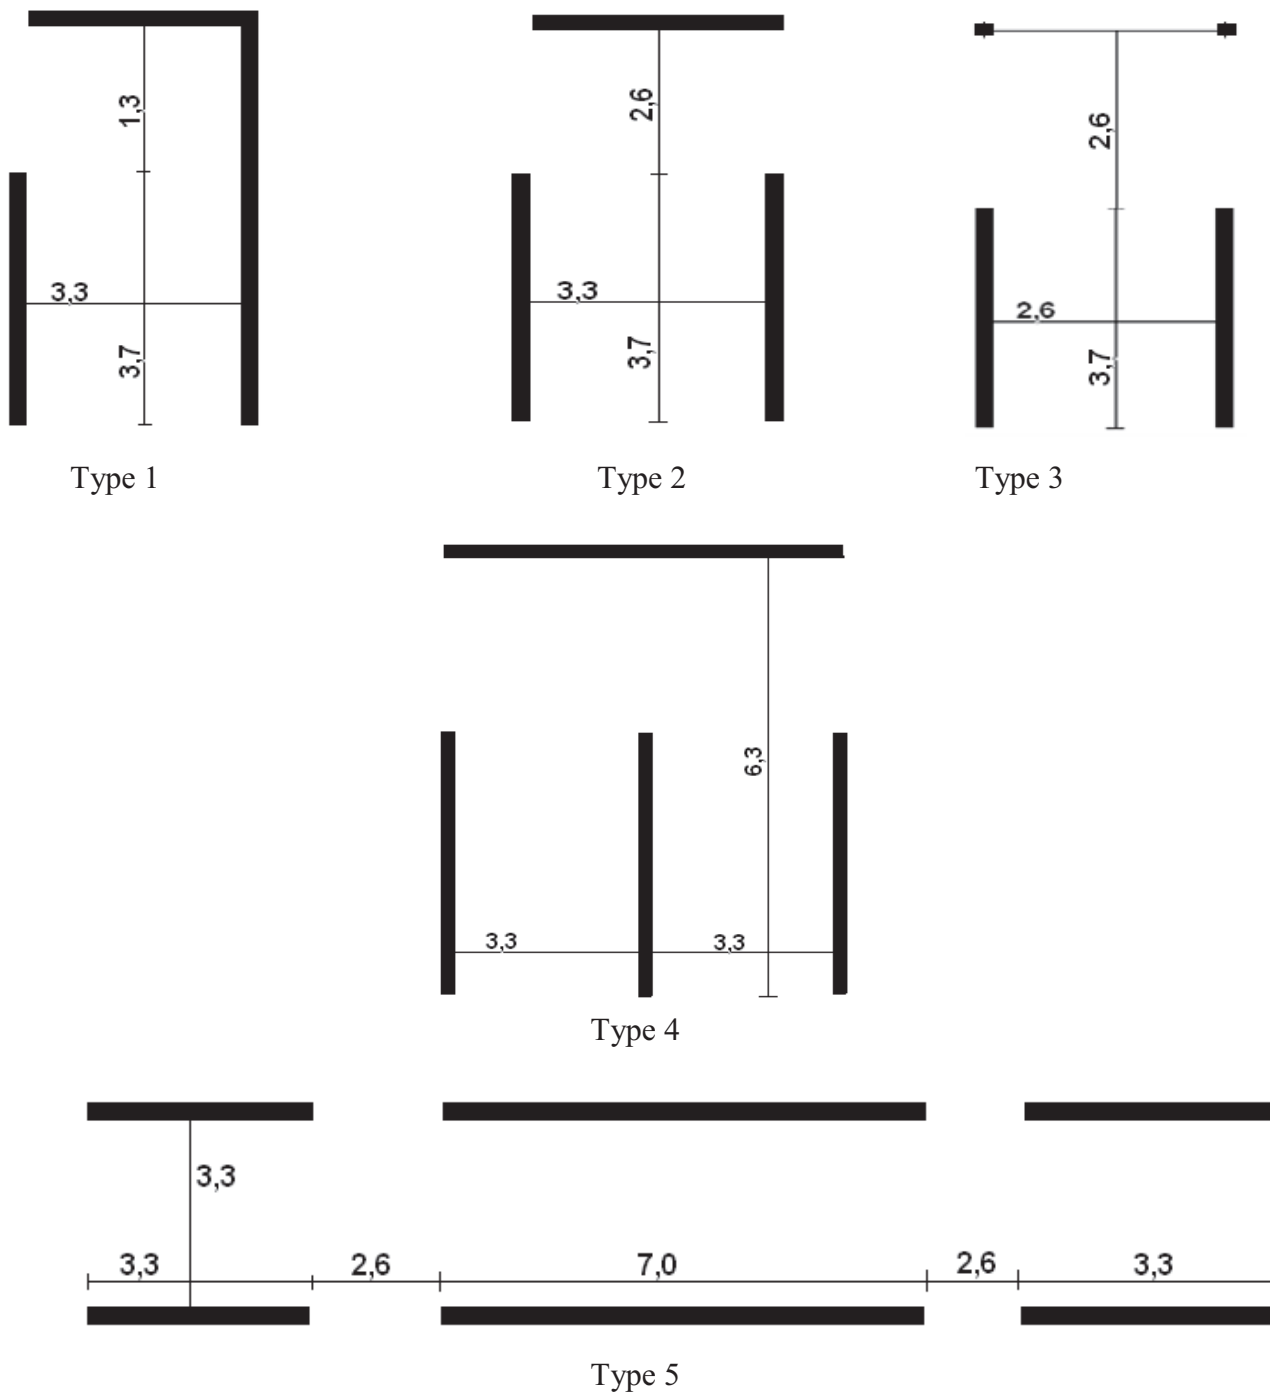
Différents types de panneaux pour le plancher terrasse
